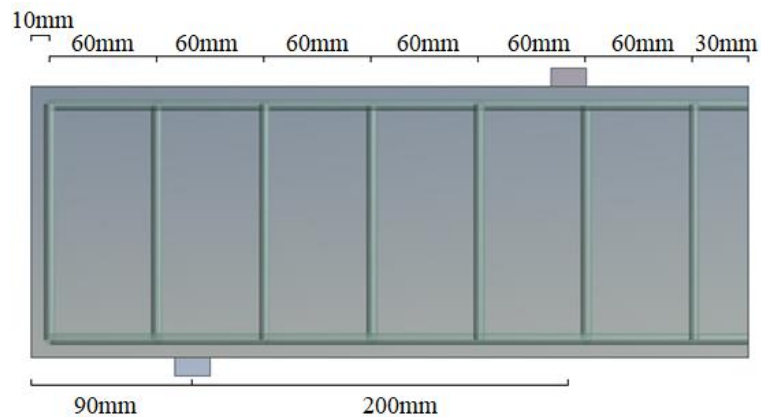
Modelagem da armadura transversal (estribos) da viga E1.
